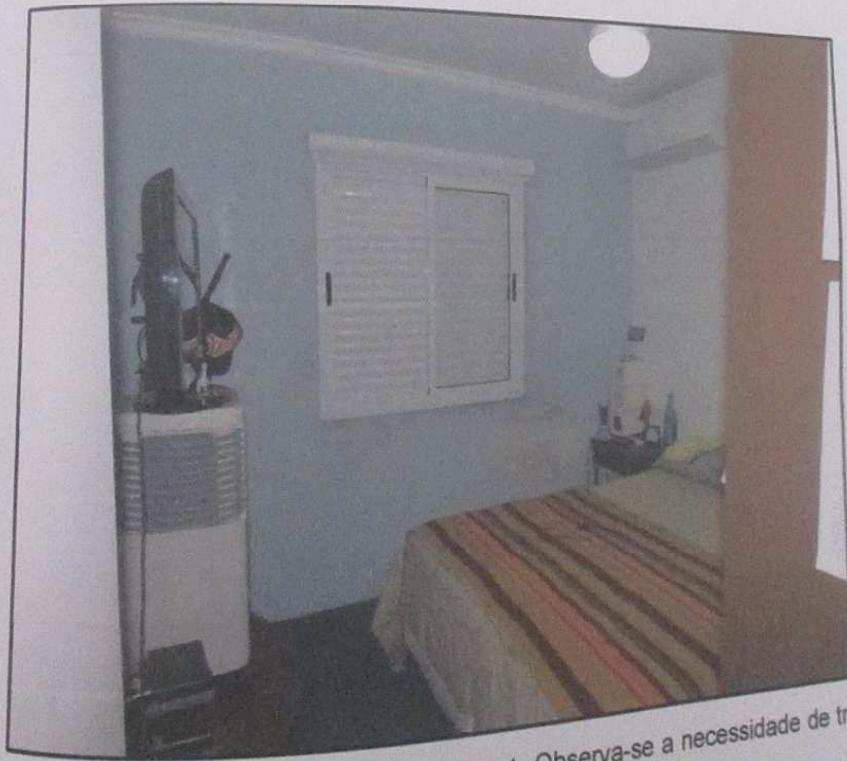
Vista parcial de um do dormitório 1. Observa-se a necessidade de tratamento de infiltrações pelo caixilho.
